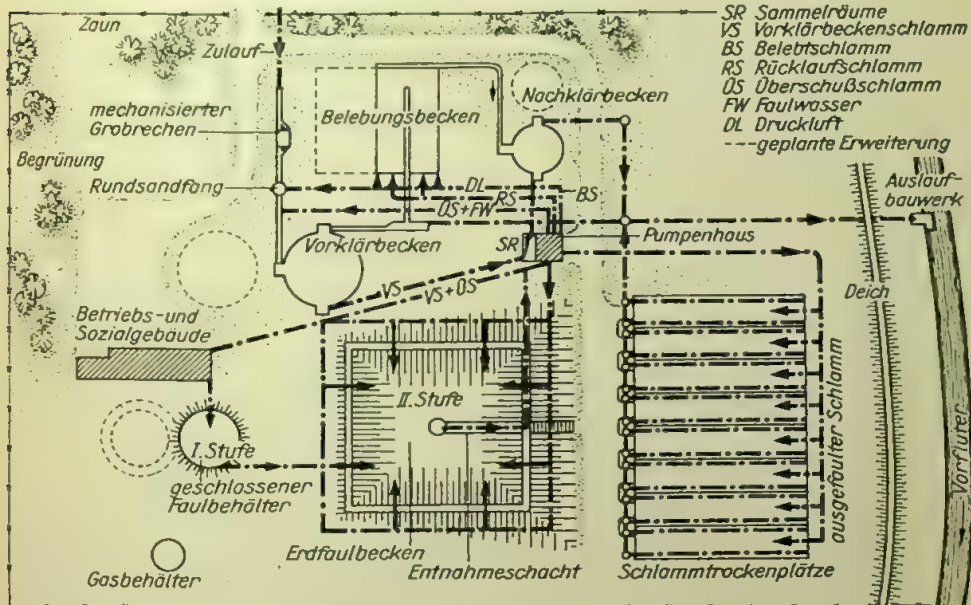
Lageplan einer Kläranlage mit Belebungsanlage und zweistufiger Faulung
